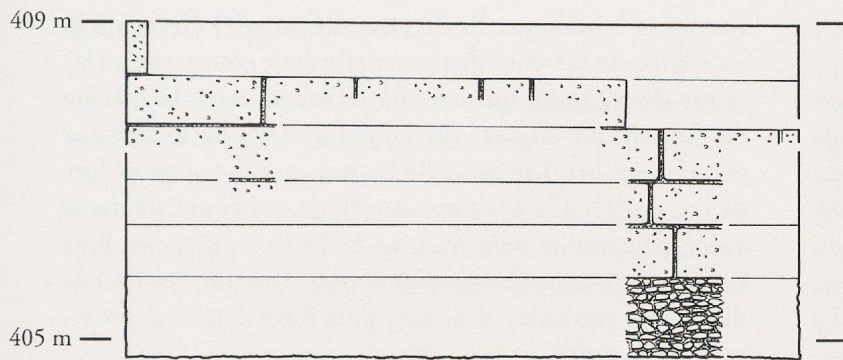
Secteur de l'entrée, vue du parement en tuf et de la fondation du mur IV⁵ (éch. 1:100).
